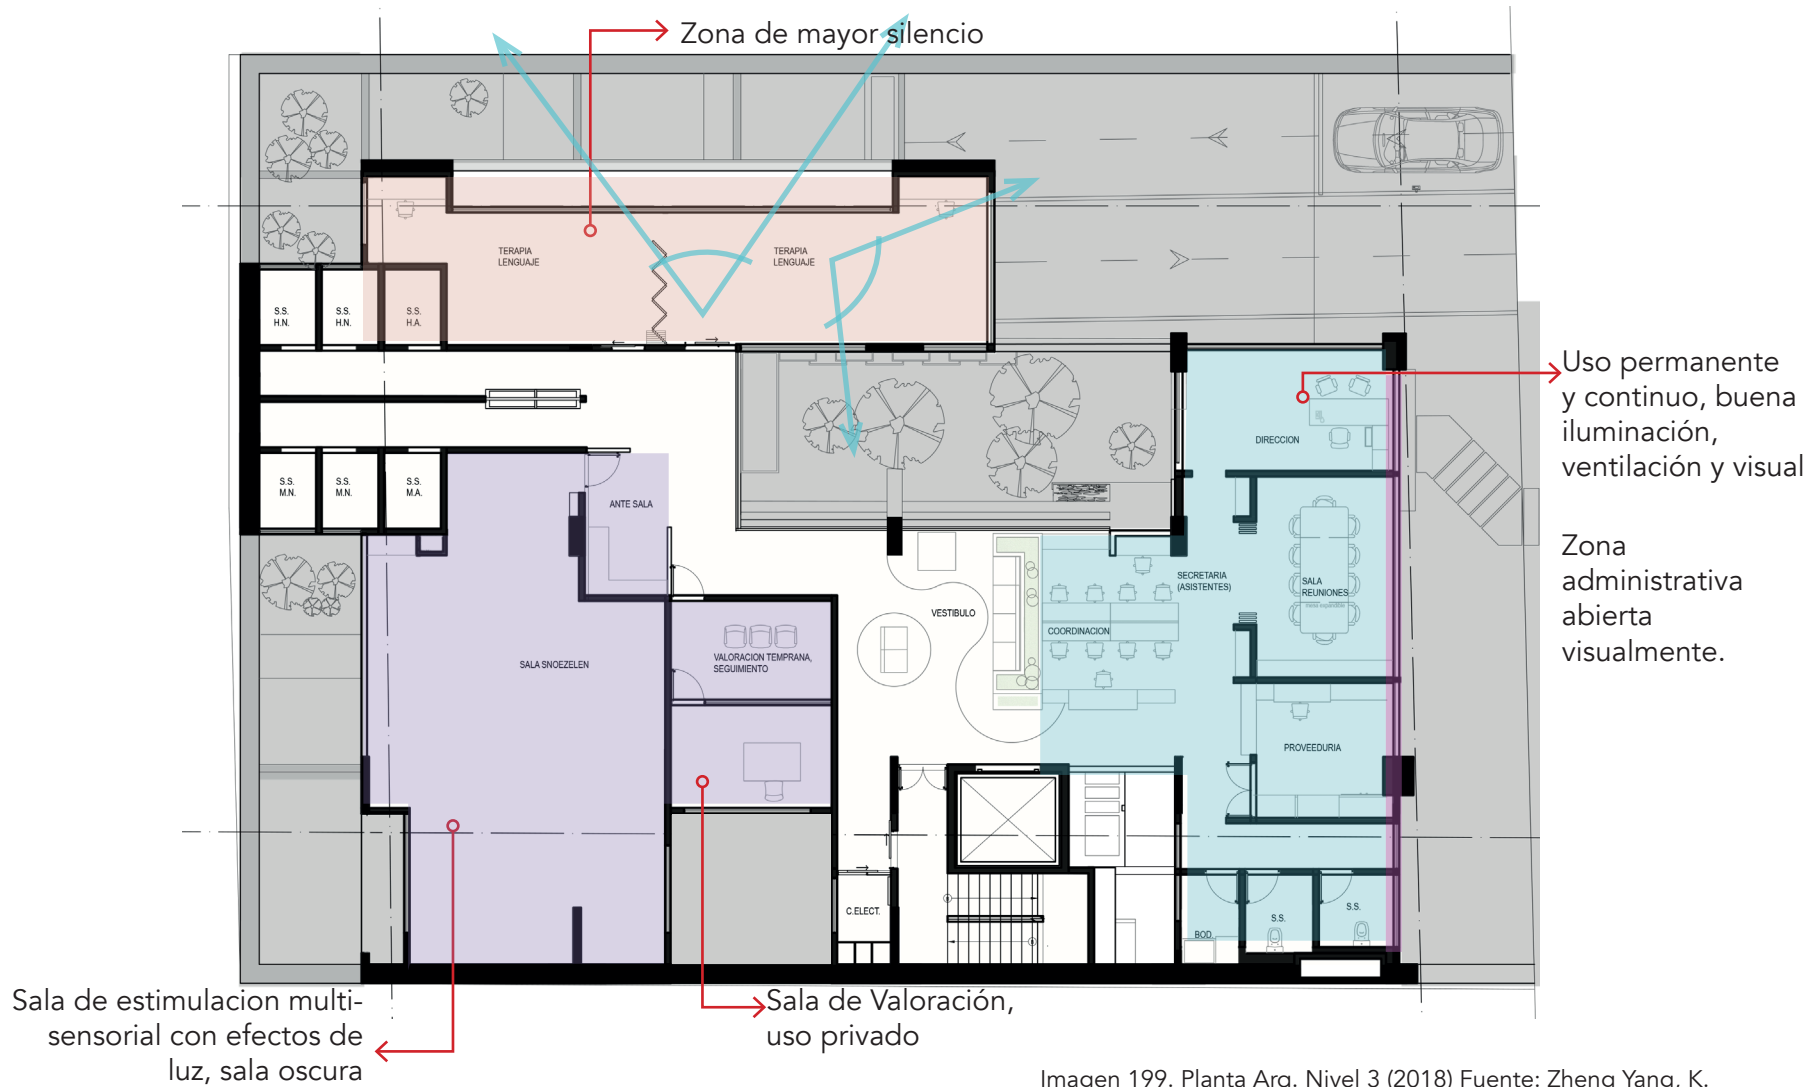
Planta Arq. Nivel 3 (2018) Fuente: Zheng Yang, K.
